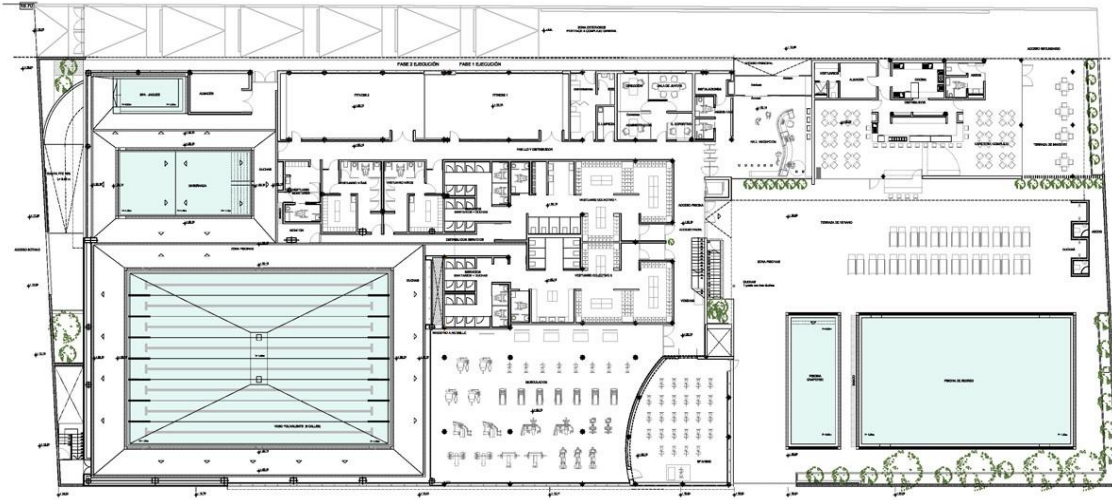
Planta del Centro Acuático. (Fuente: <https://www.archdaily.pe> Centro Acuático)
